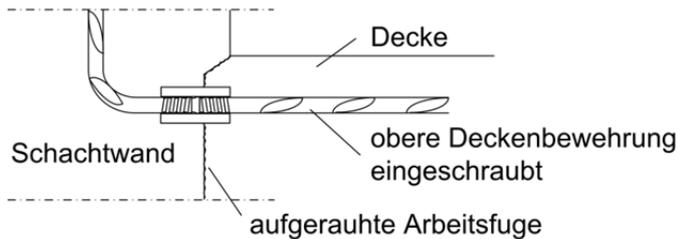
Deckenanschluss mit Schraubenmuffenstoss: Bauzustand - Deckenherstellung
